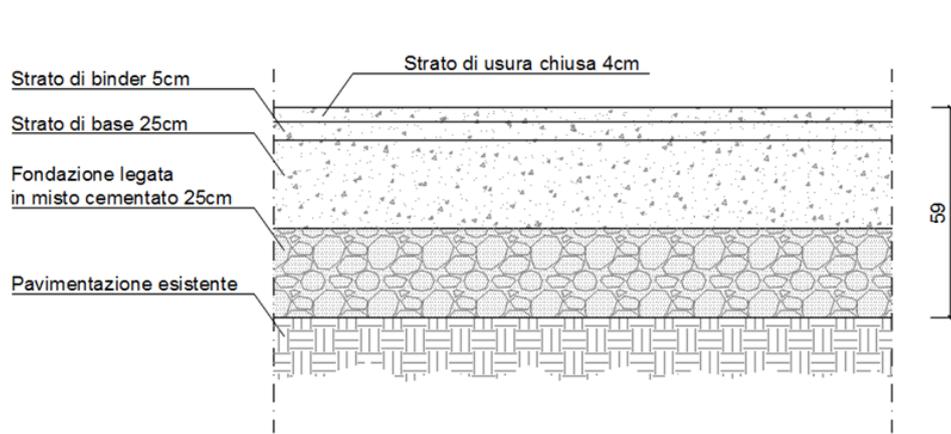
Pacchetto di ripristino pavimentazione rampe di svincolo TIPO P5B
